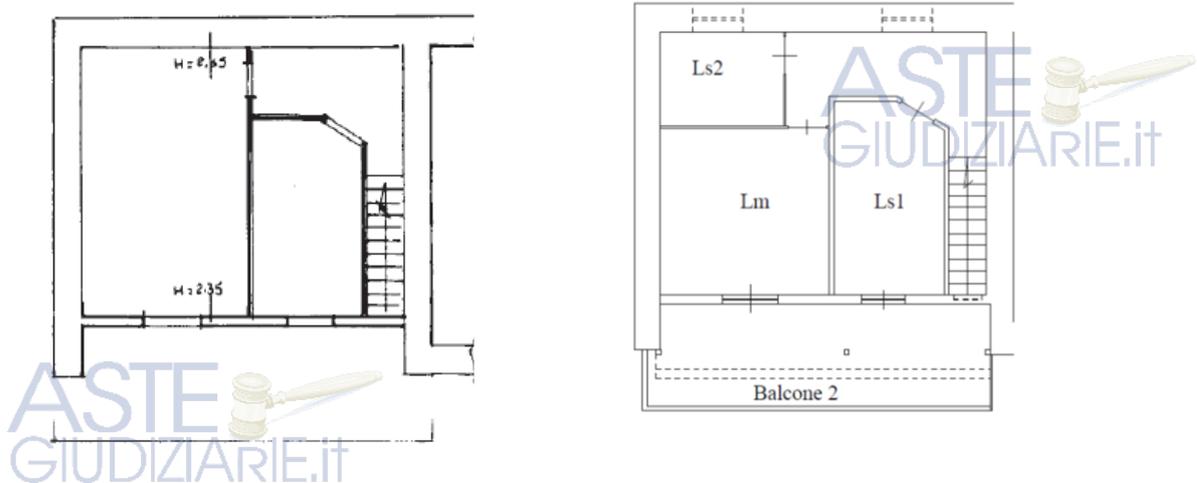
Planimetria catastale degli immobili al piano primo e grafico dei beni all'attualità.
